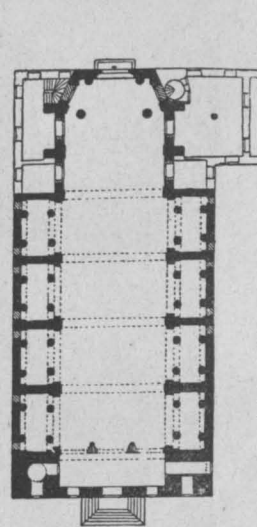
Grundriß der Jesuitenkirche, I. Bez.
